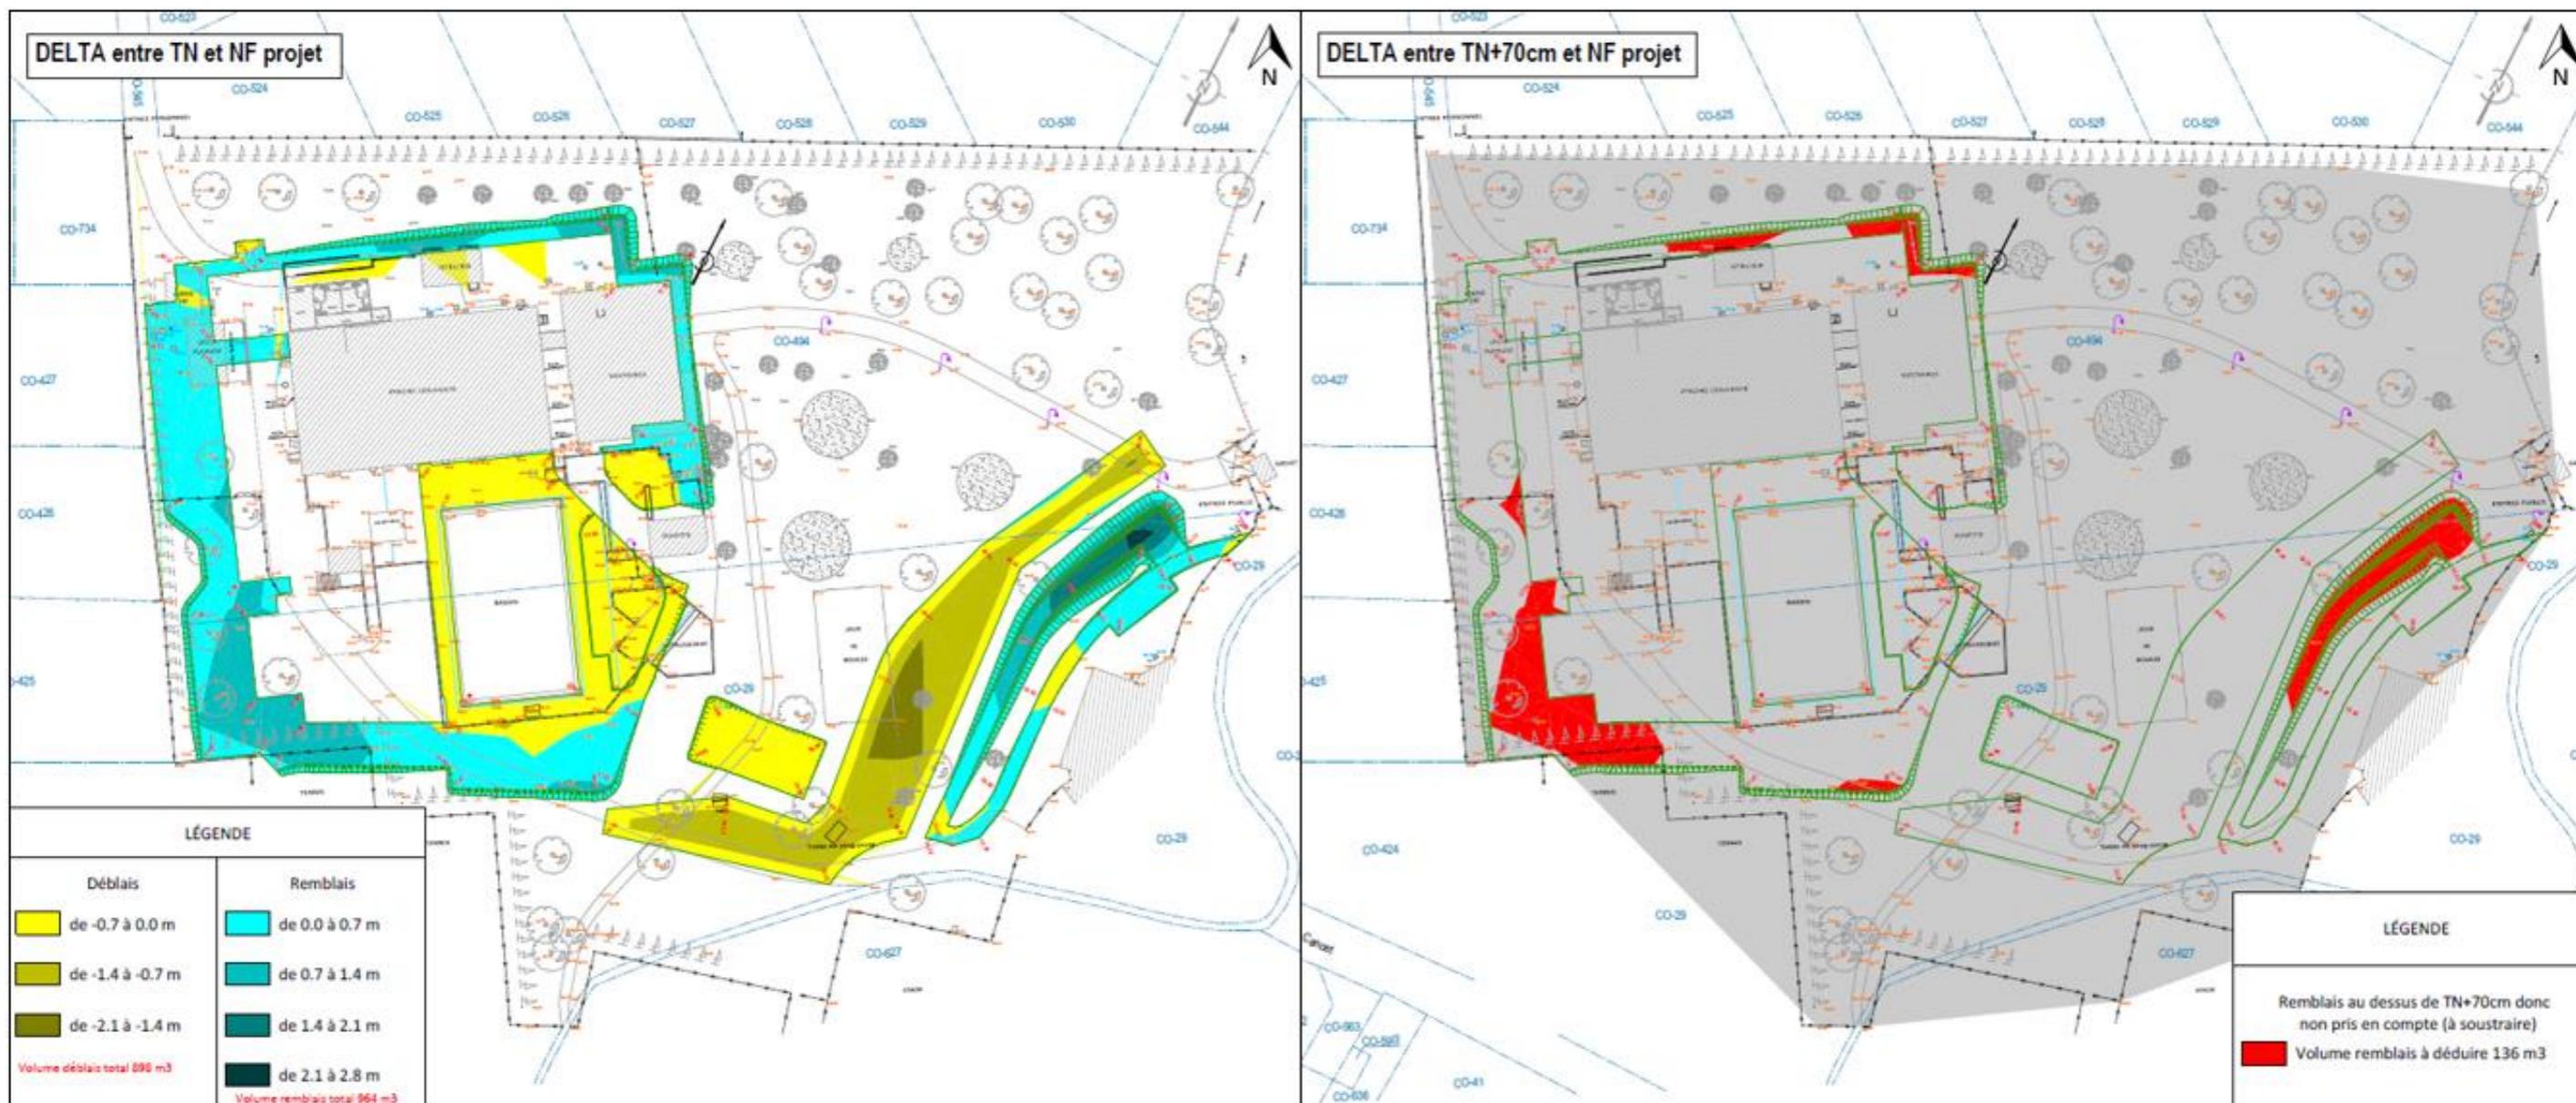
Plan des cubatures de terrassement au droit du bâtiment du projet
